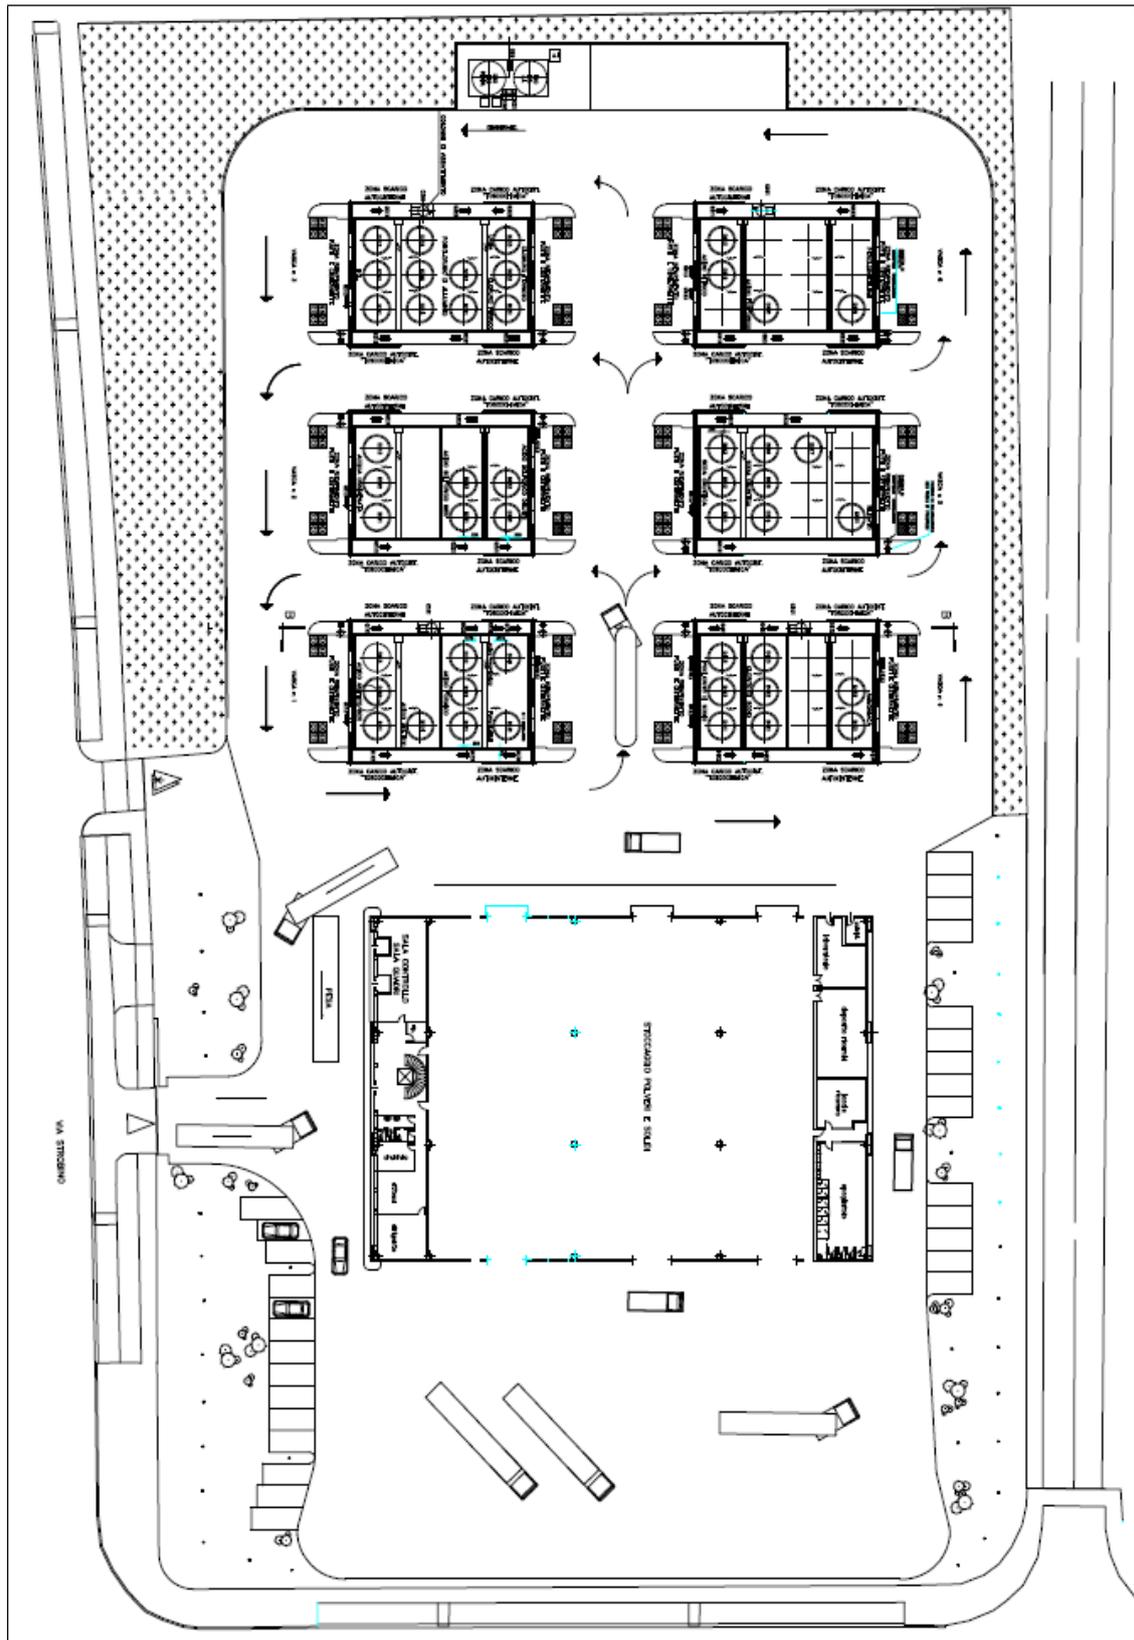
Planimetria dello stabilimento Toscochimica (Fonte: Piano di Protezione Civile comunale)
